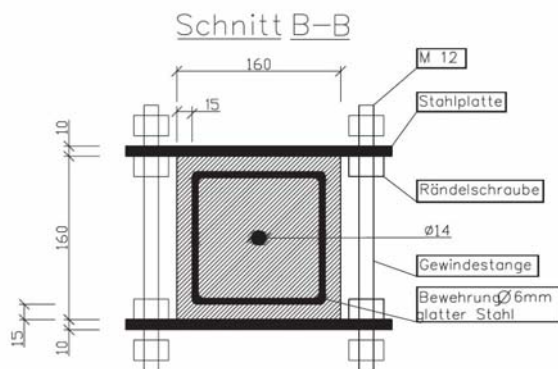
Vorrichtung zur Einstellung der Rissbreiten: Konstruktion und Ausführung.
